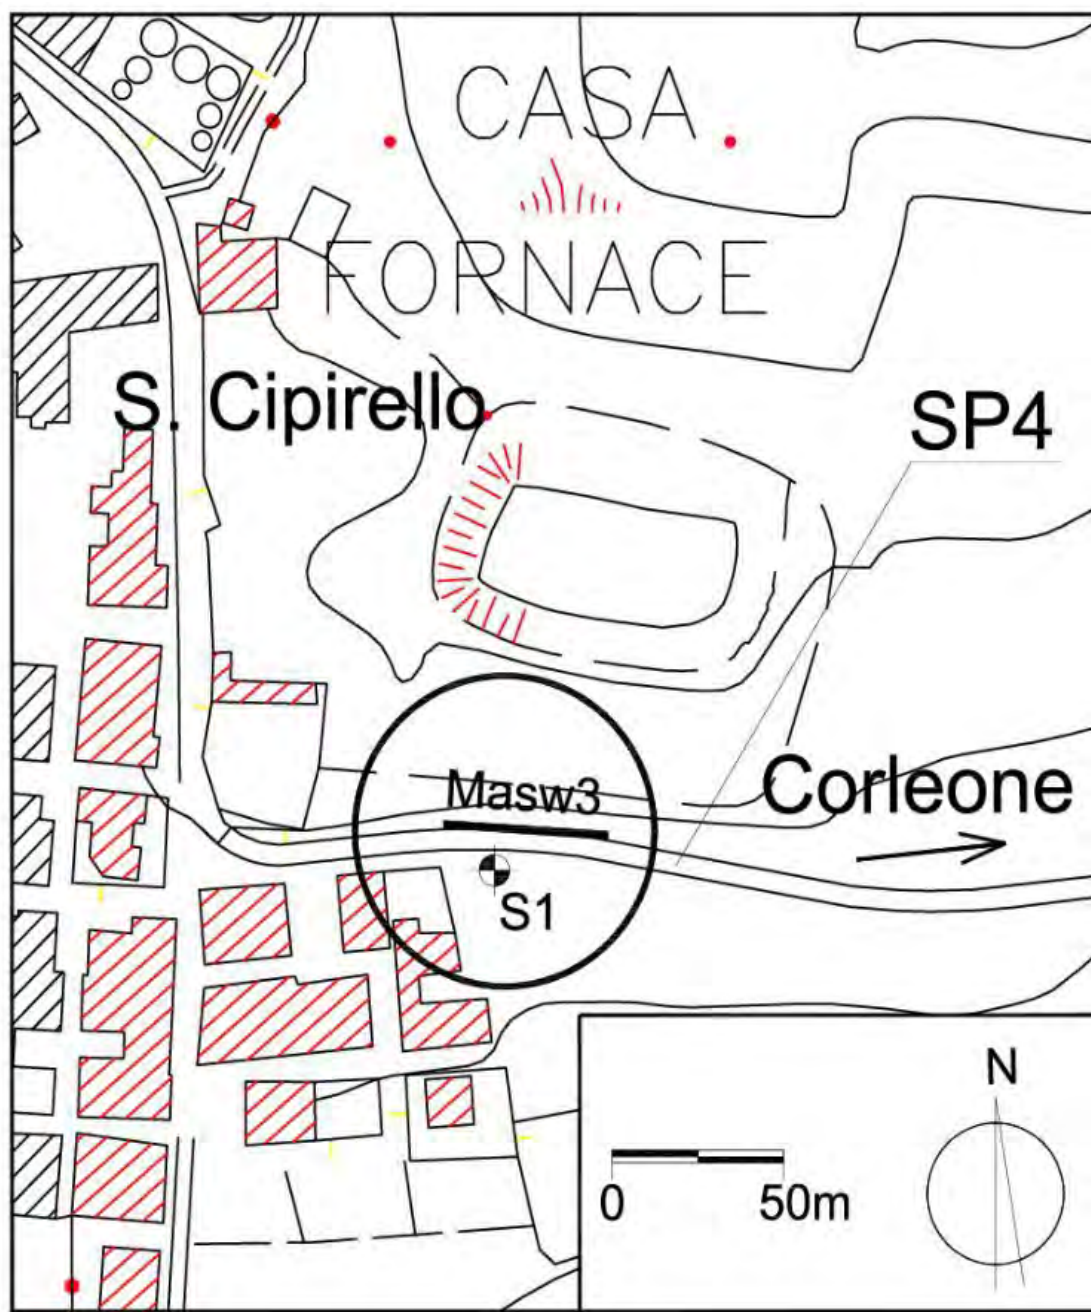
Planimetria con indicazione della zona oggetto di interesse al km 0+500e delle indagini eseguite. Il sondaggio S1 è stato attrezzato con piezometro a tubo aperto.
